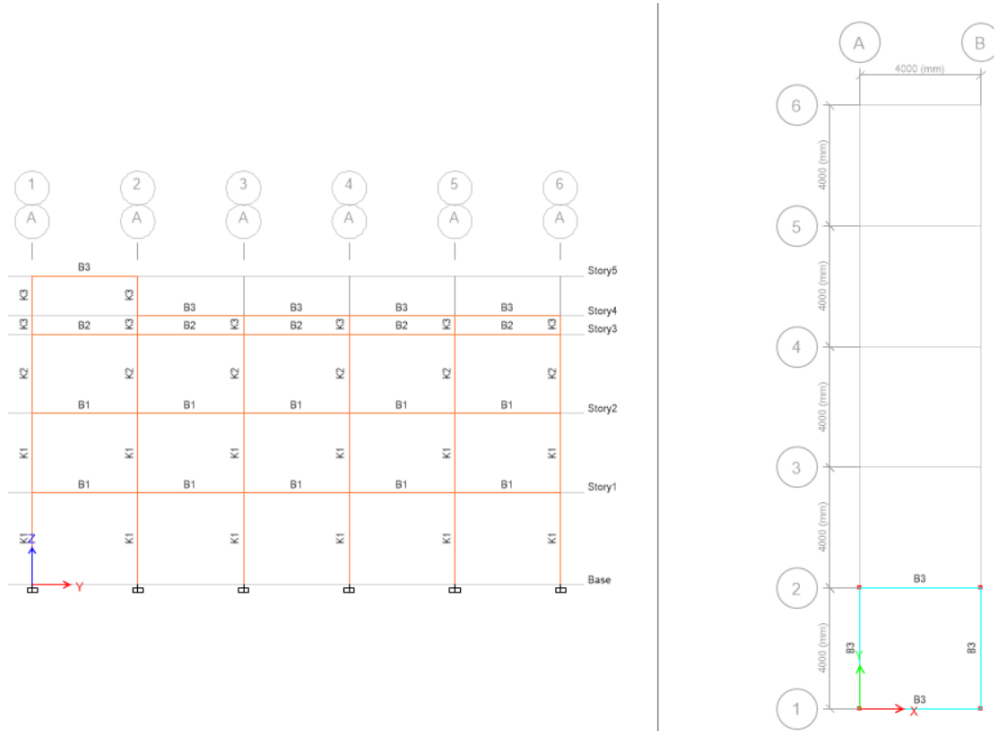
Denah balok B3 Tingkat 4 dan Tampak A-A
